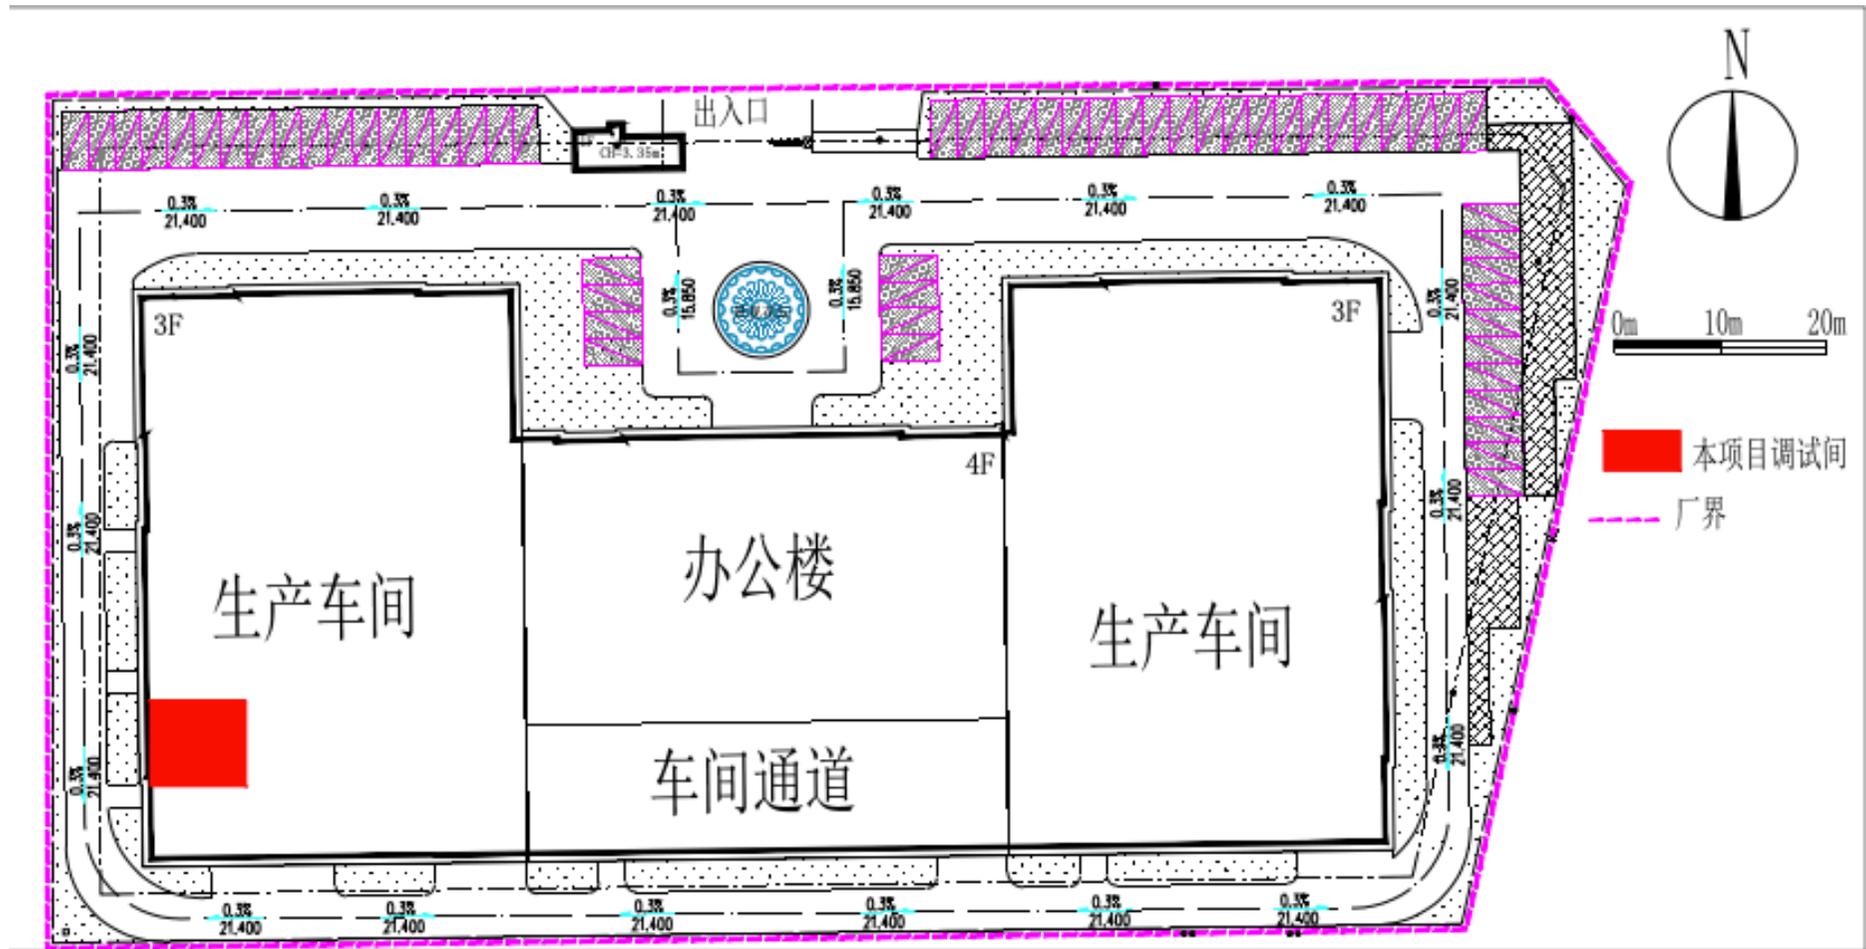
俐玛精密测量技术（苏州）有限公司厂区总平面布置图
